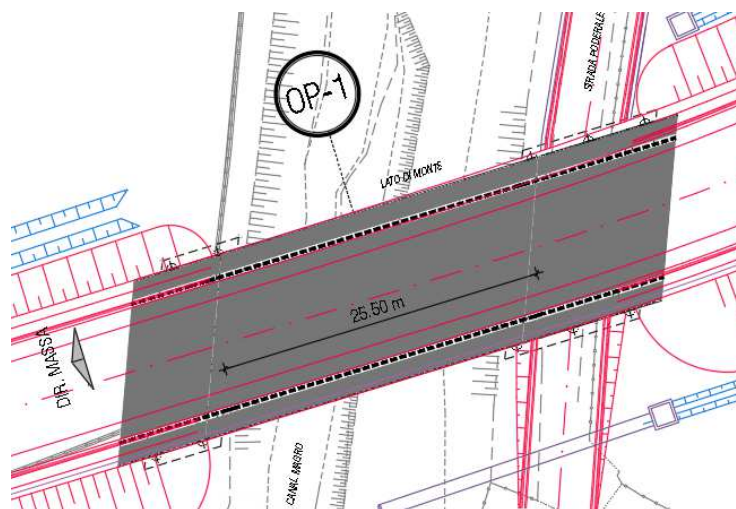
Ponte sul canal magro – estratto planimetria di inquadramento
